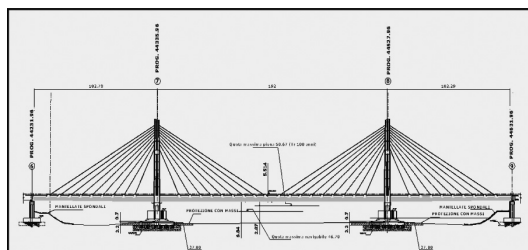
Prospetto longitudinale del ponte strallato sul Po.
